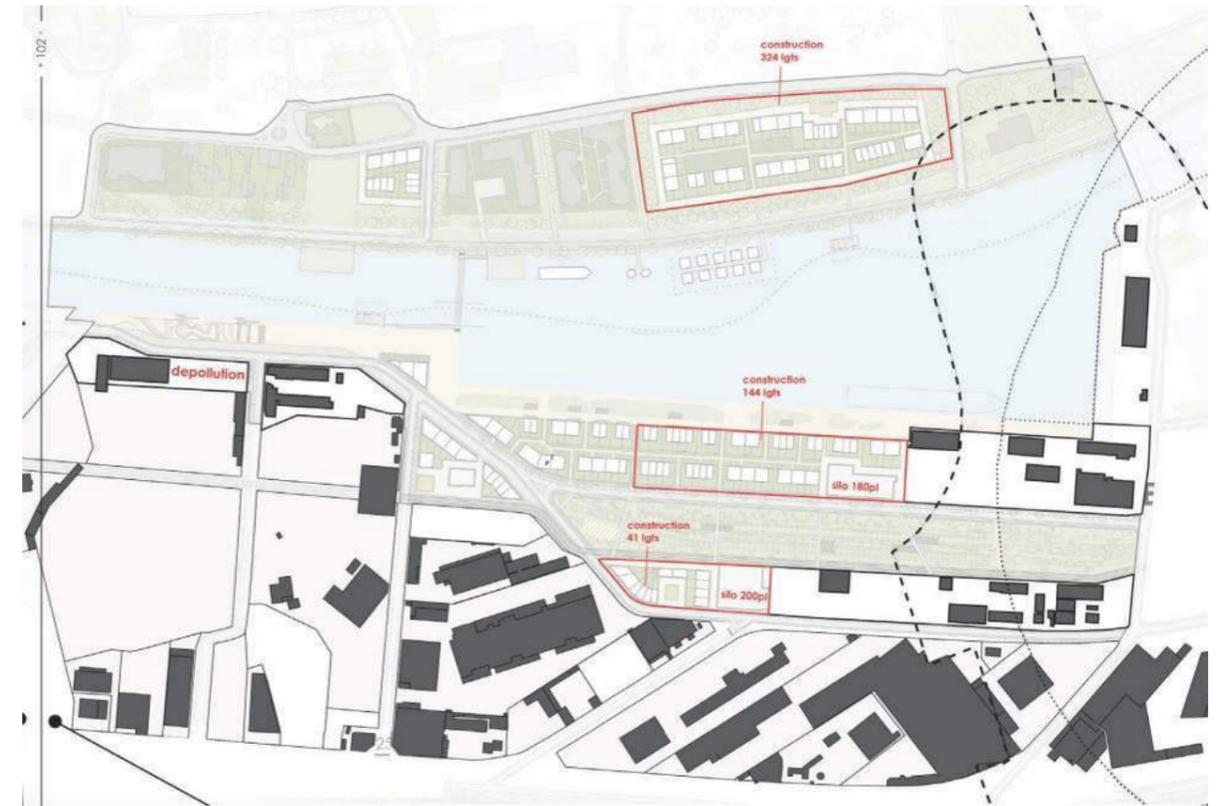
Phase 3 autour du Canal – Site Nouveau Bassin à Caen (source : Plan Guide MVRDV)
